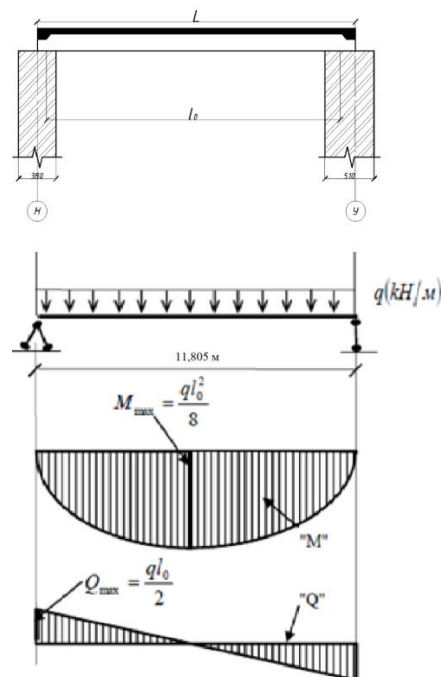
Расчетная схема, расчетный пролет и эпюра усилий
